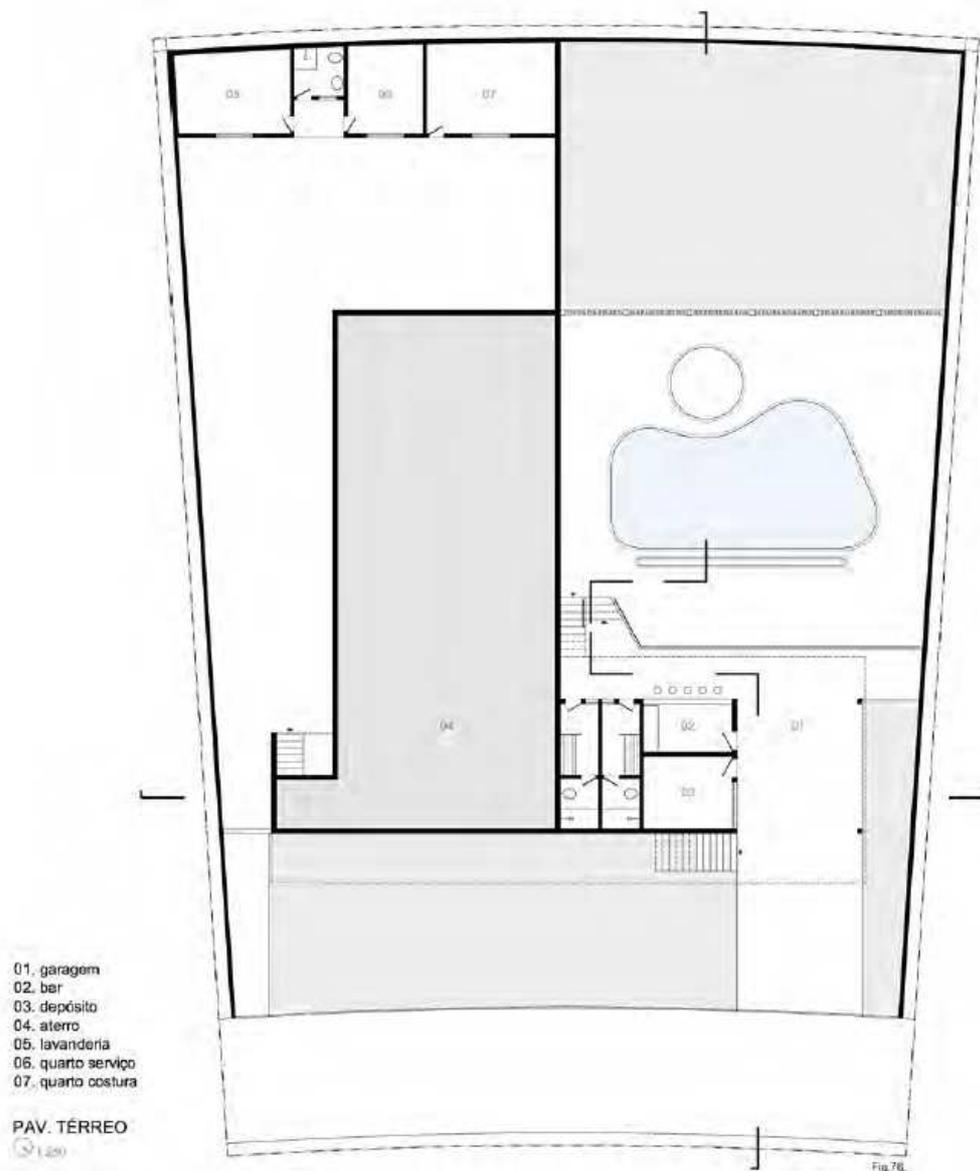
| PLANTA BAIXA TÉRREO CASA EURIPEDES FERREIRA, 1961 – EURICO DE GODOY. SILVA NETO, 2010.
